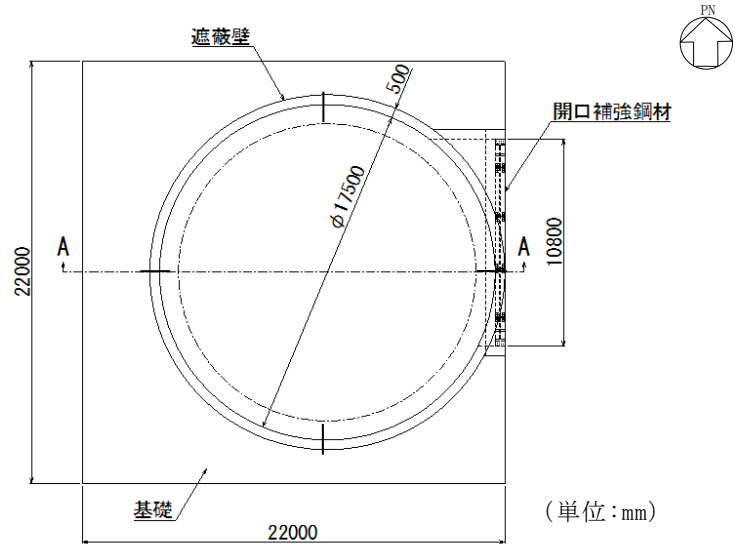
復水貯蔵タンク遮蔽壁 平面図
